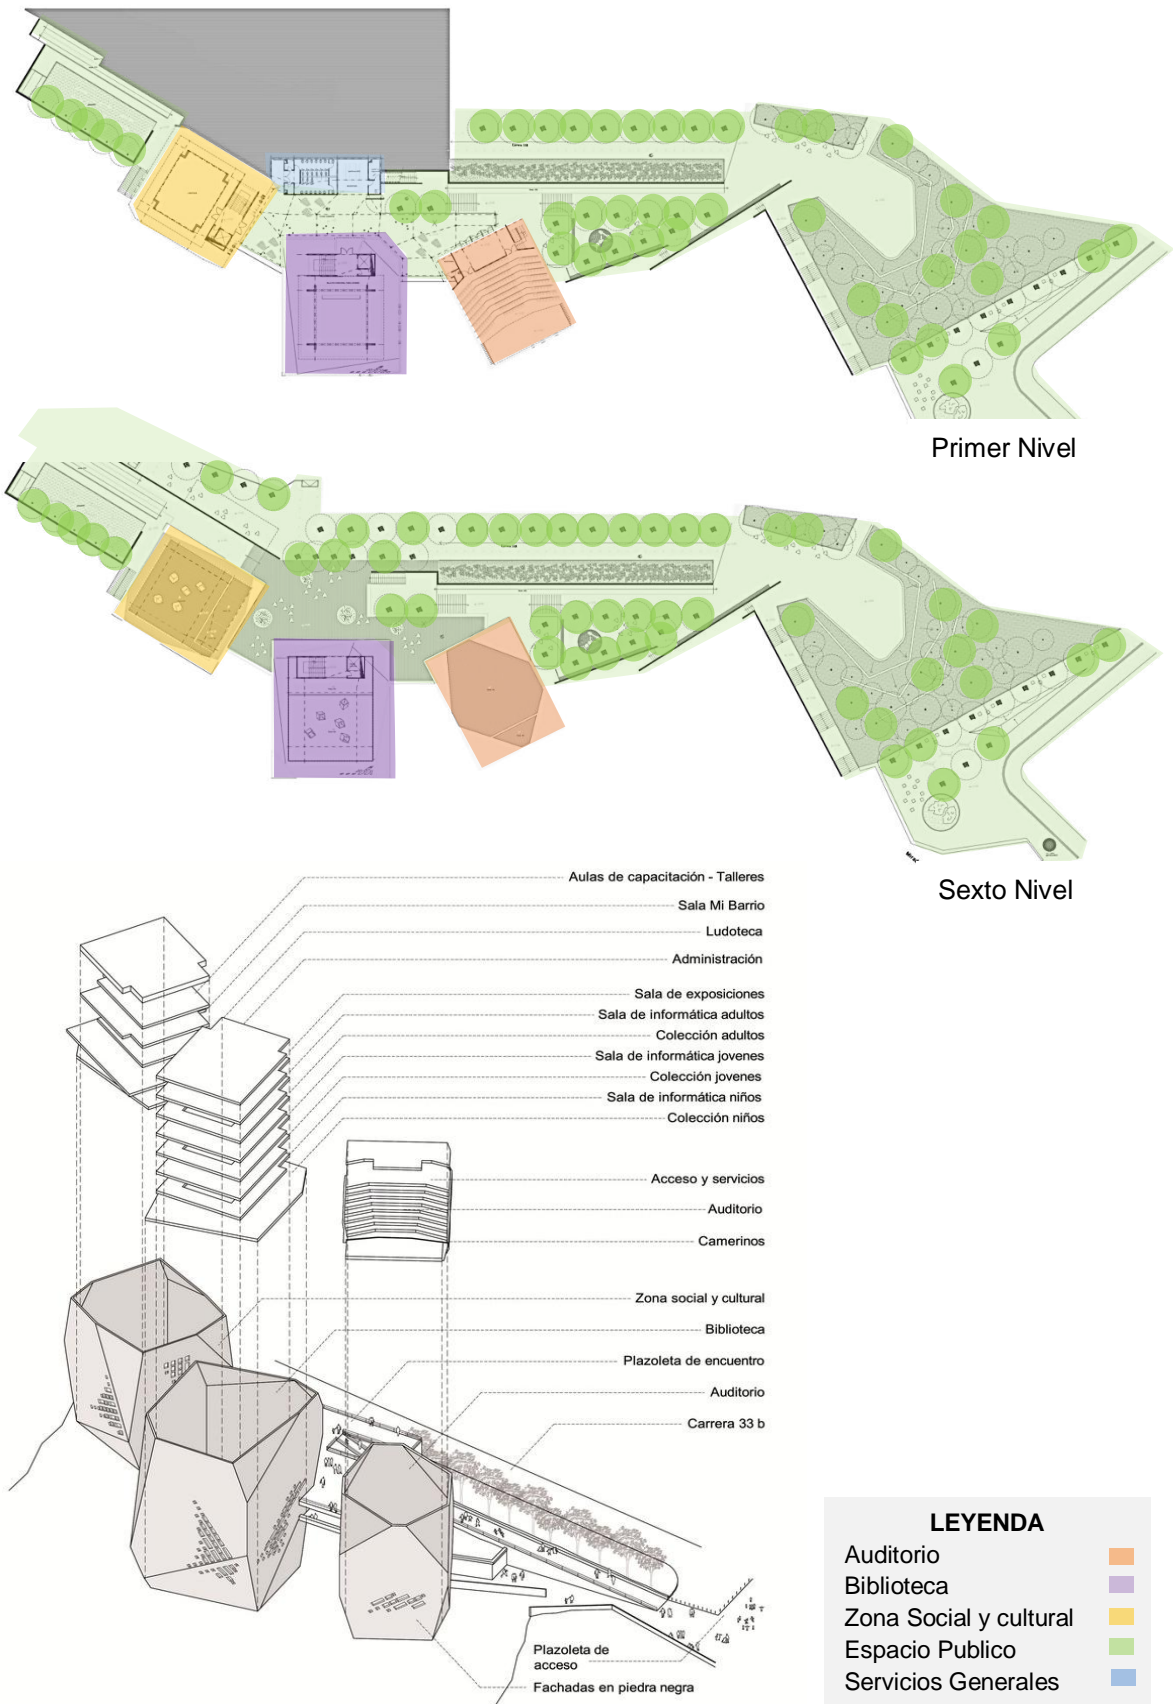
Plantas Arquitectónicas y Zonificación, Biblioteca España
